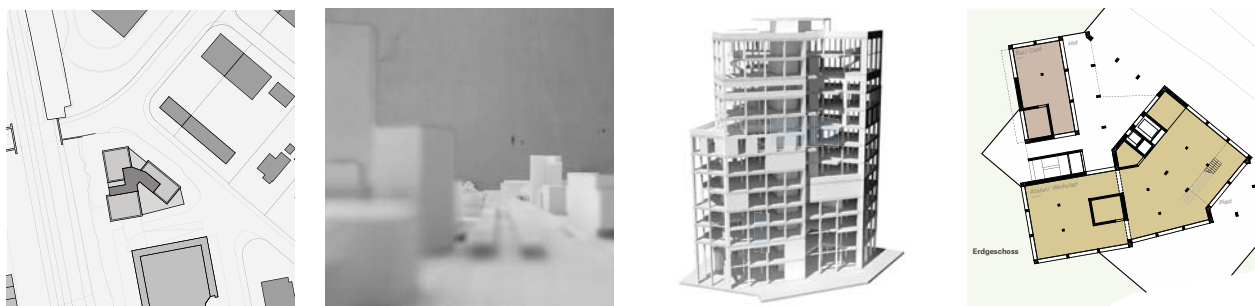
Variante A: v.l.n.r. Situation, Modell, 3D, Grundriss Erdgeschoss
